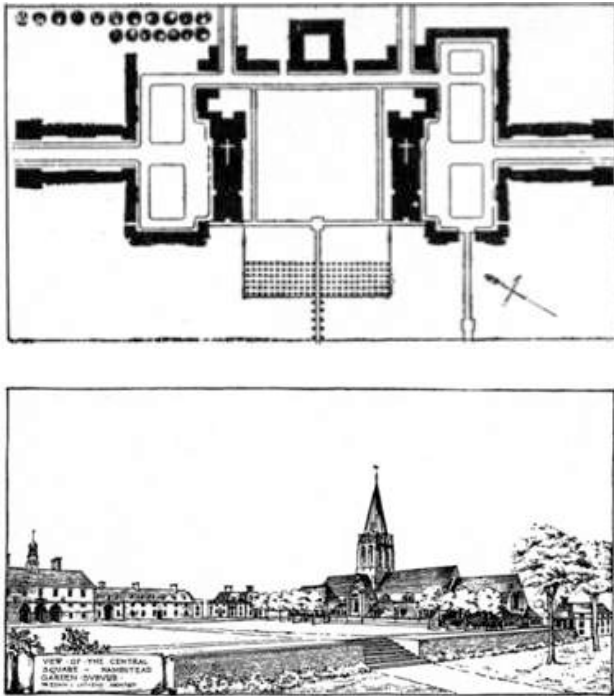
Planimetria e vista prospettica della piazza centrale di Hampstead garden suburb di Edwin Lutyens, improntata ad una simmetria di ispirazione classica.
